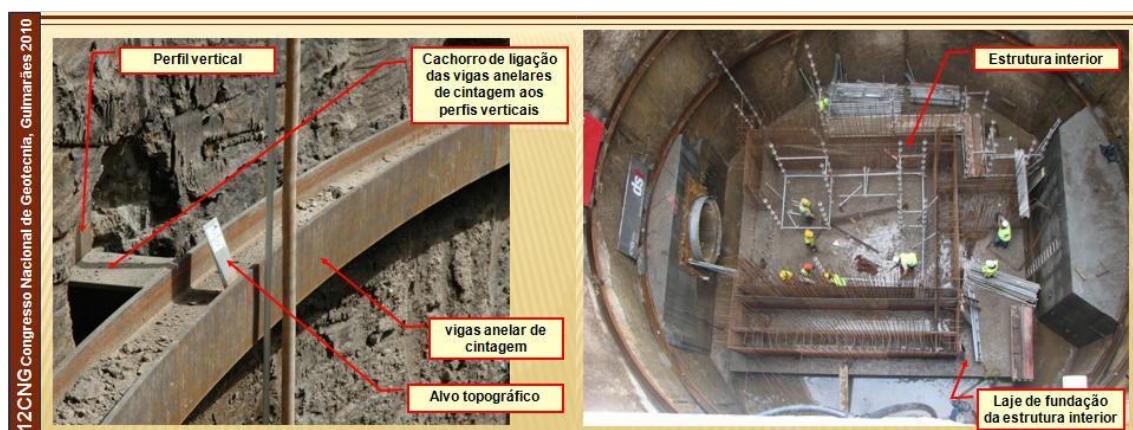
Ligação das vigas de cintagem aos perfis verticais e vista da execução da estrutura interior
